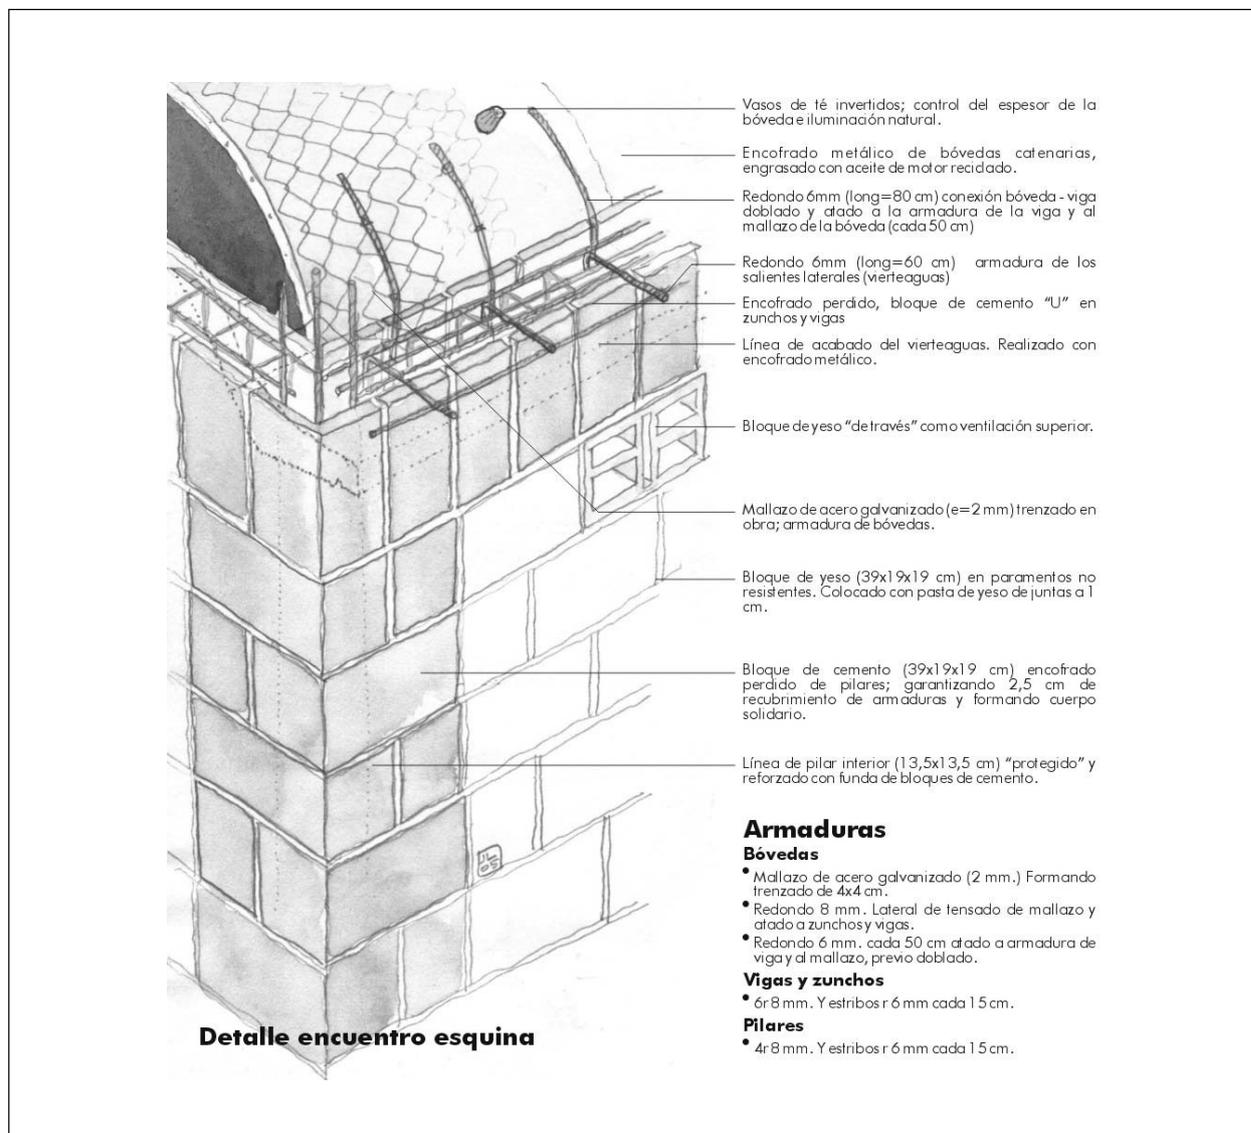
Esquema del encuentro de la bóveda de hormigón armado con la viga y los cerramientos. (J.J. Legarra).
